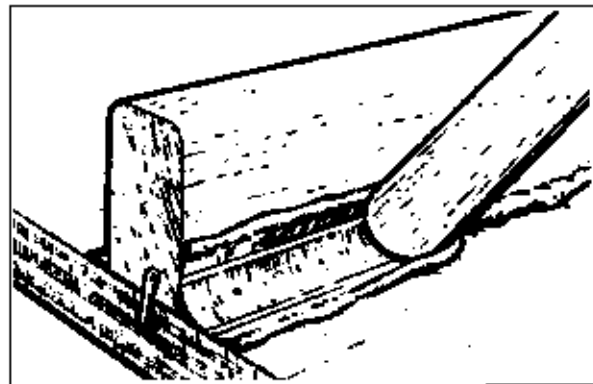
Formen Sie die Spachtelkehle mit einem gerundeten Werkzeug aus und glätten Sie die Kehle.
